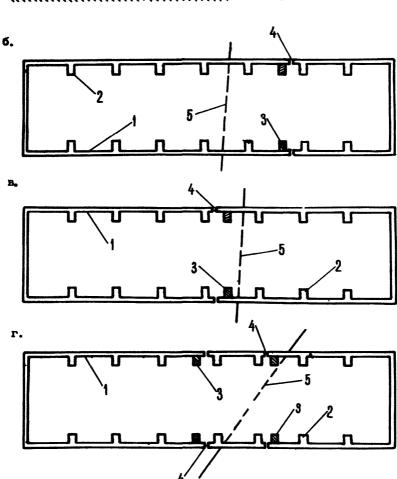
Схемы разрезки на отсеки каменного бескаркасного здания в зависимости от положения устука в плане:
